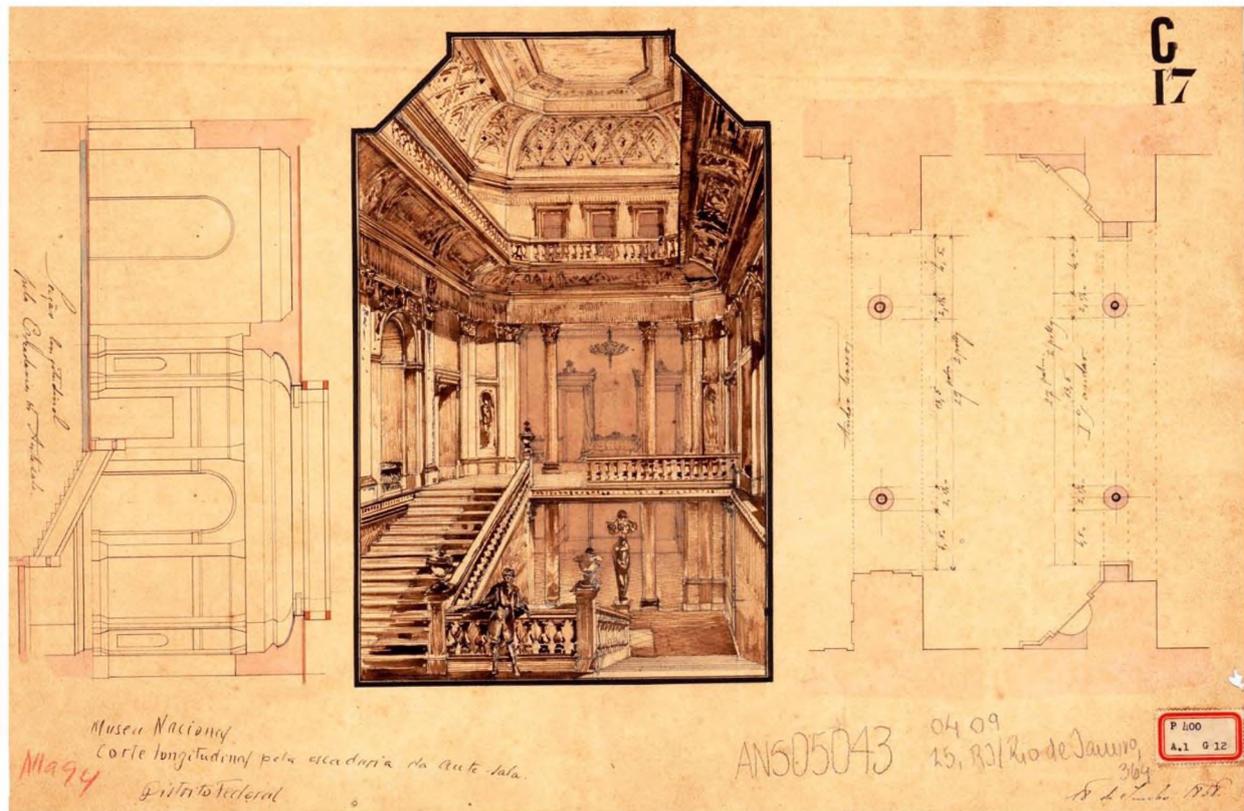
Planta, corte e perspectiva de escada. Arquivo Central do Iphan
